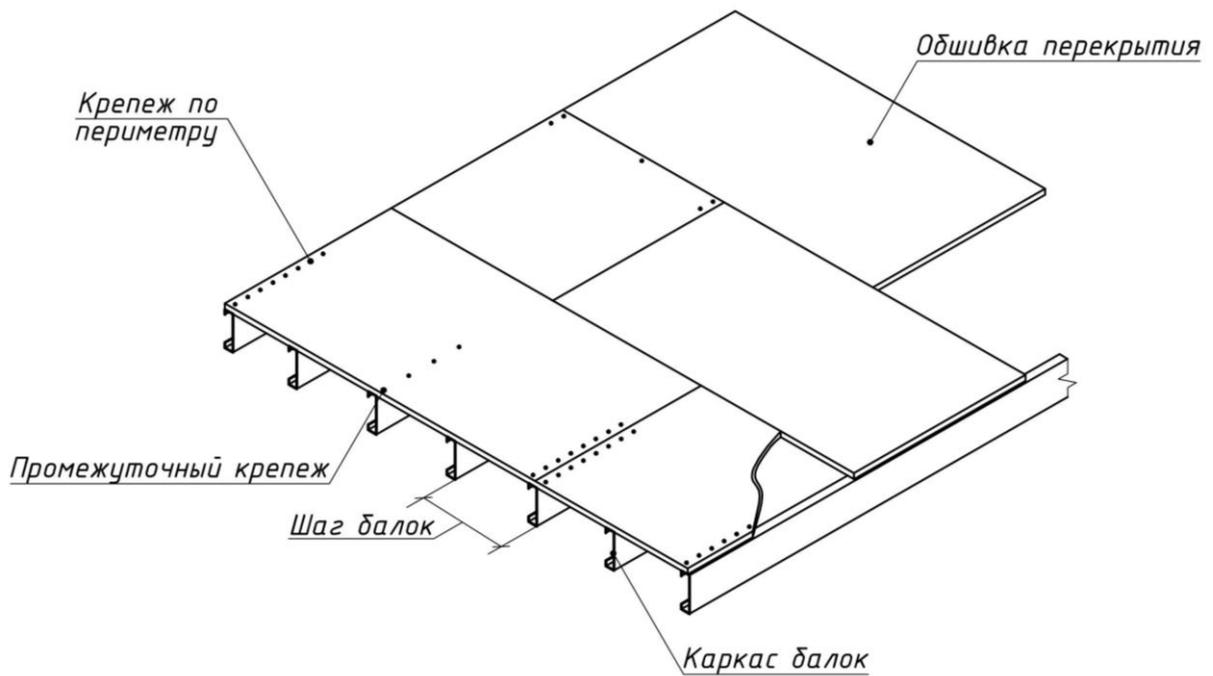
Узел П 27. Крепление обшивки перекрытия
